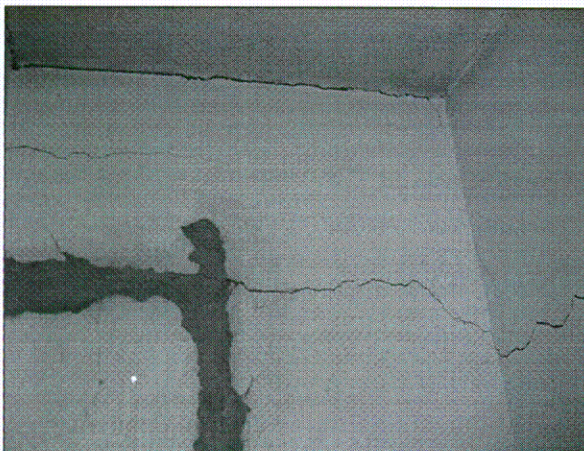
Grietas en la parte superior del muro oriental del cuarto piso. Baño ilustrado en la foto No. 3.
